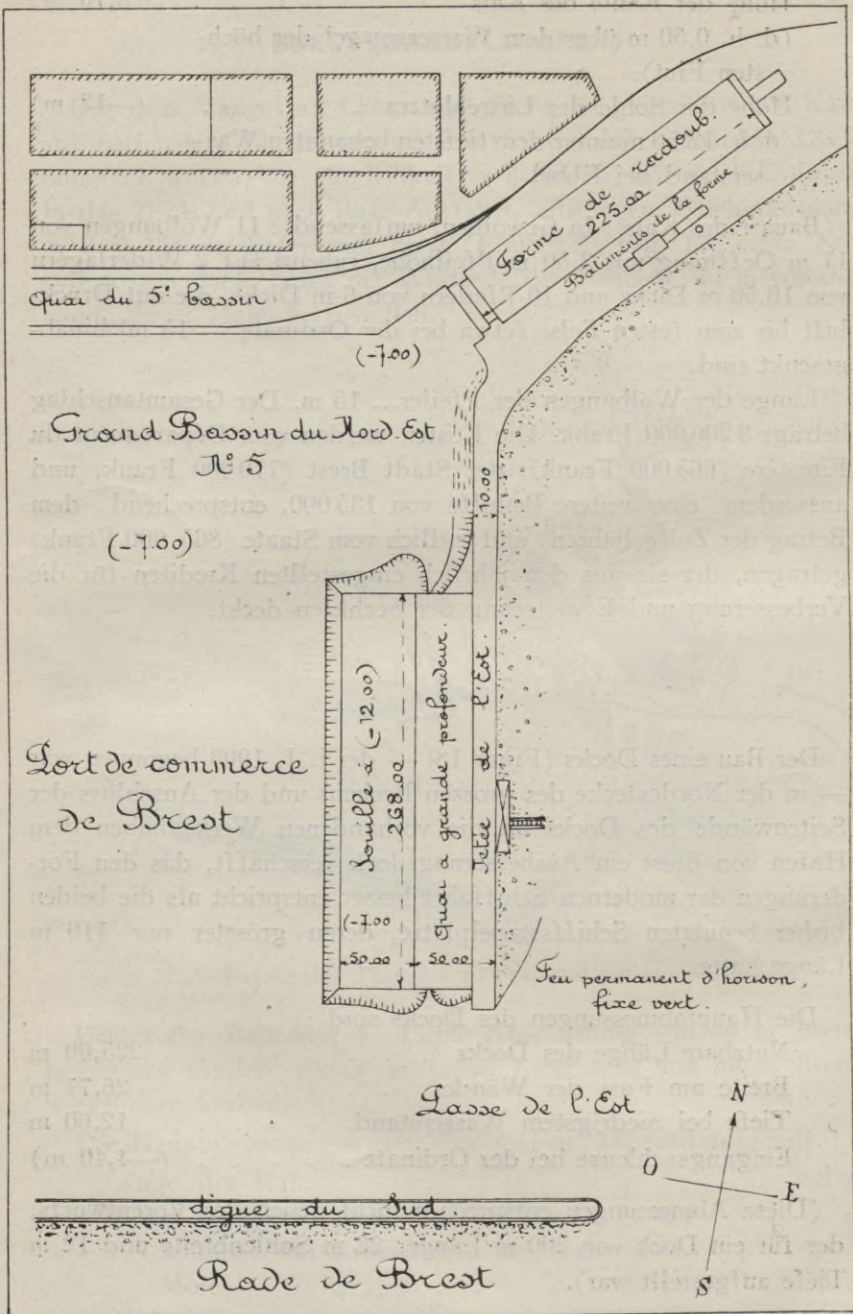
Teilplan des Hafens von Brest mit Angabe der auszuführenden Bauten.
